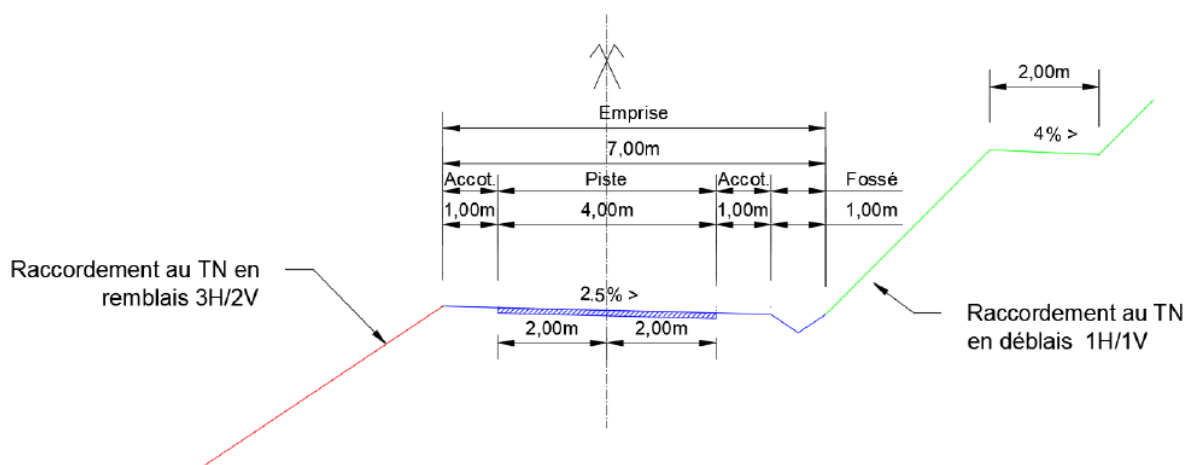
Profil en travers de la piste interne au site (source : BECIB)
